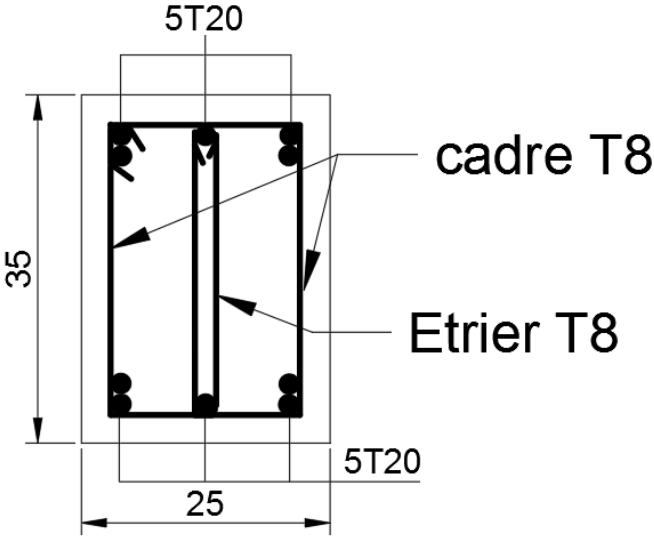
Ferrailage des poutres non porteuses sur travée
